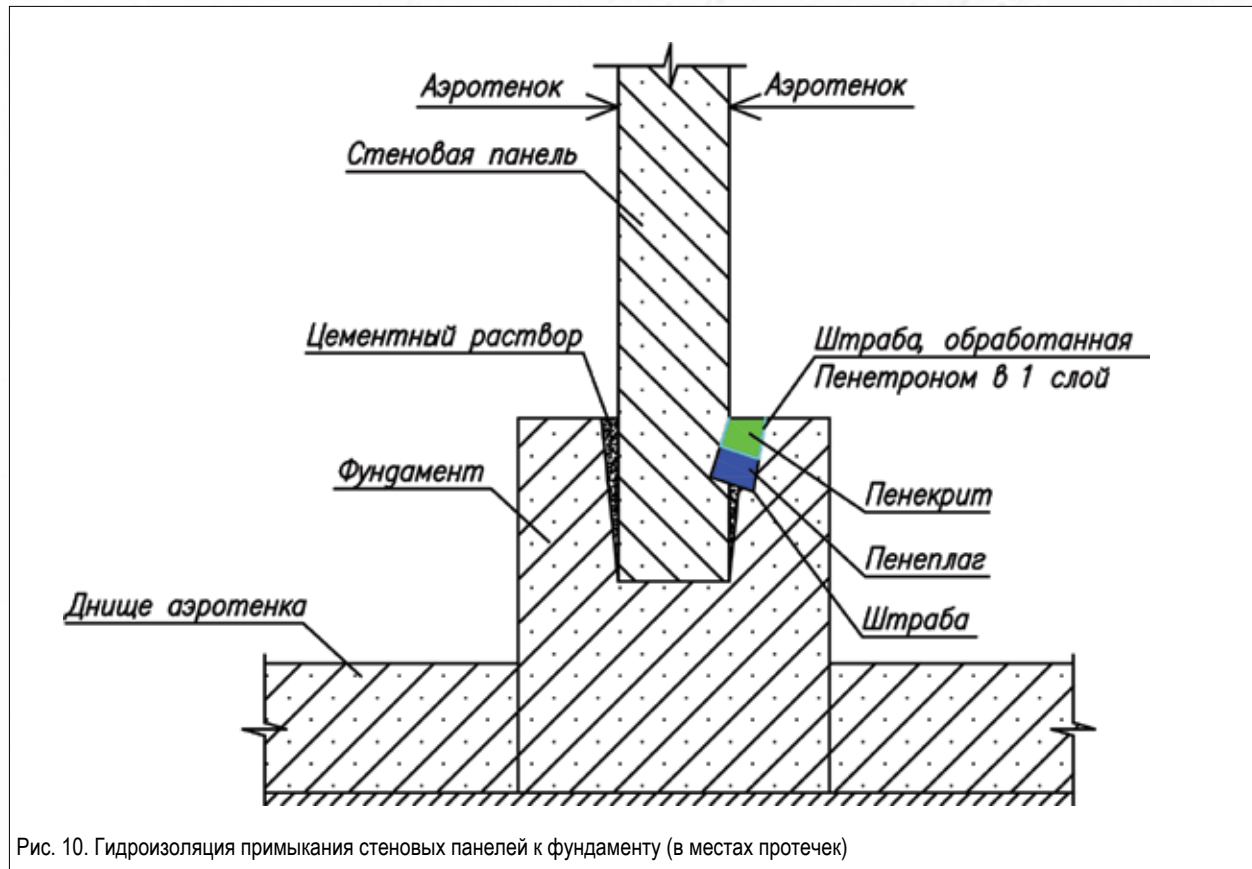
Гидроизоляция примыкания стеновых панелей к фундаменту (в местах протечек)
